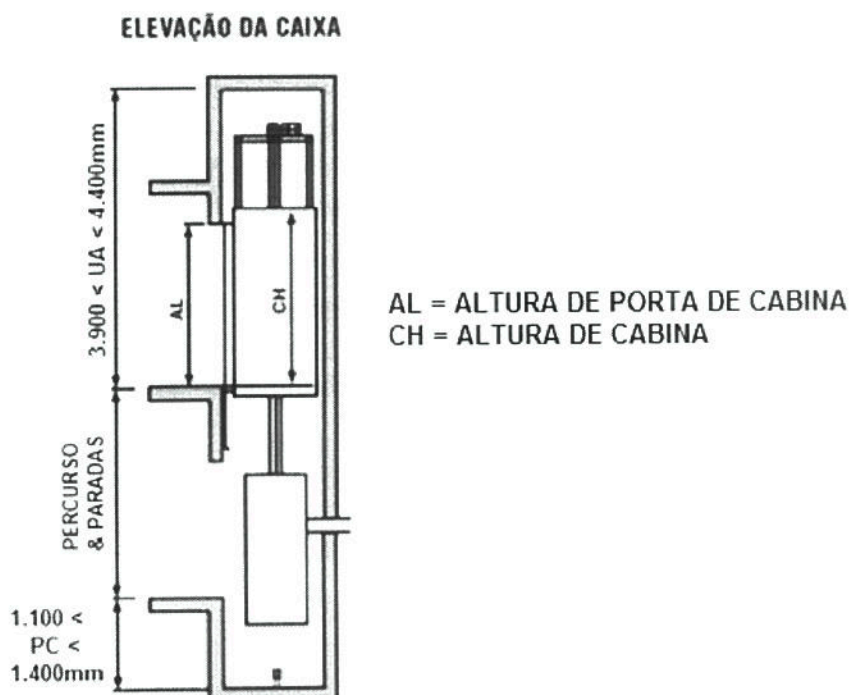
Croqui em elevação da caixa de corrida do elevador evidenciando última altura (UA) e profundidade do poço (PC).
